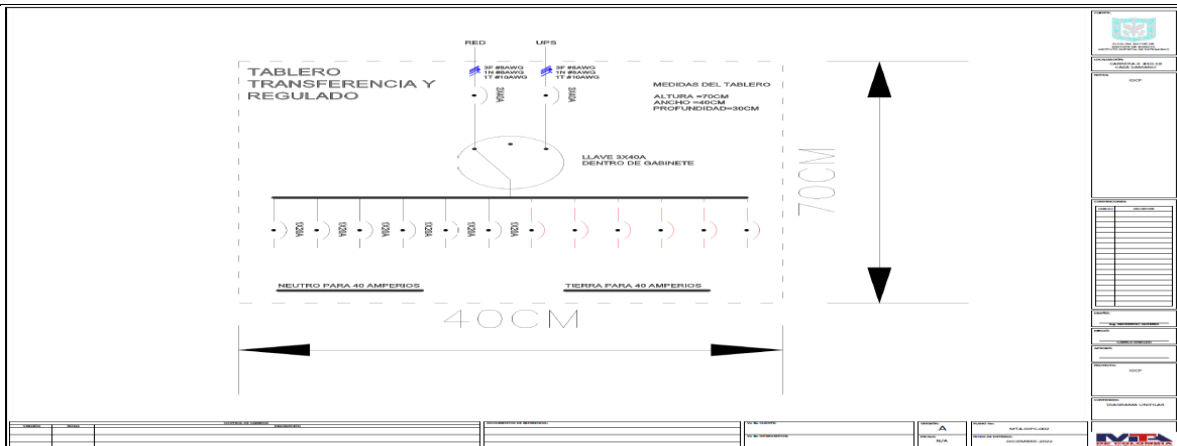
plano eléctrico Bypass Ups 10 kva
